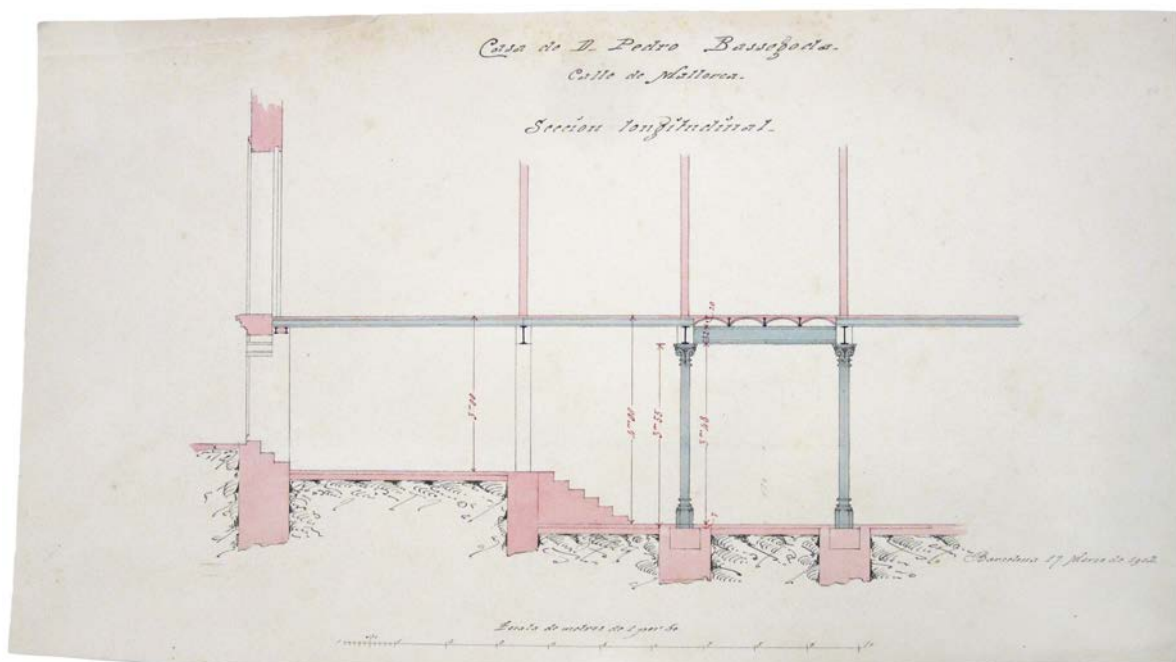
Plànol de secció longitudinal de les primeres crugies de planta soterrani (casa Pere Bassegoda, arquitectes Bassegoda, 1902). Font: AHCOAC H121A/9/443.
